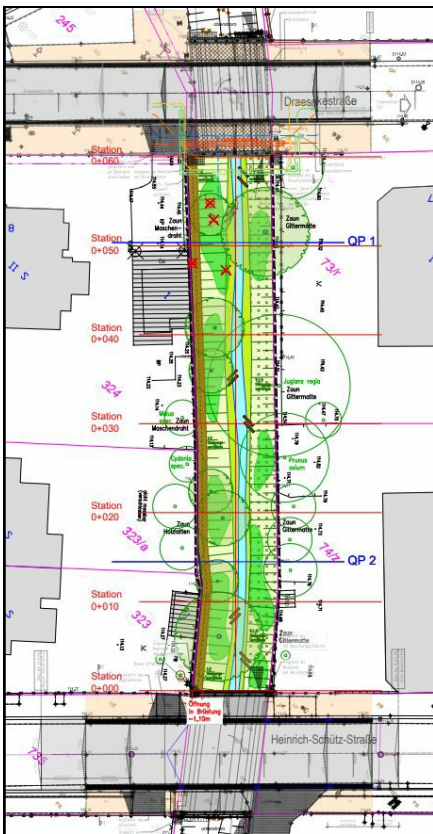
Lageplan Maßnahmebereich, 06.11.2020
